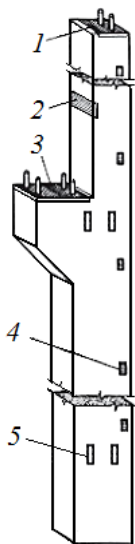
Основні закладні деталі колон: 1 – закладна деталь (анкери) для кріплення конструкцій покриття; 2, 3 – те ж, для кріплення підкранової балки; 4 – те ж саме, для стінових панелей, 5 – те ж саме, для вертикальних зв'язків
